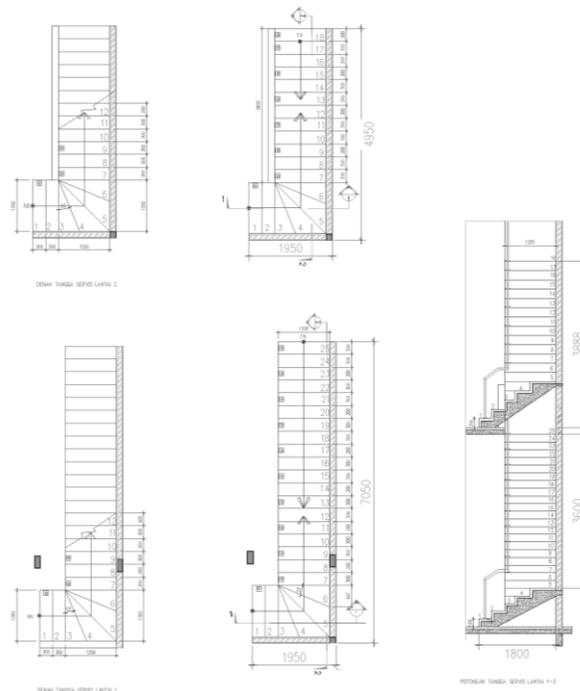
11. Revisi detail potongan vertikal pada tangga servis lantai 1 menuju lantai 2
